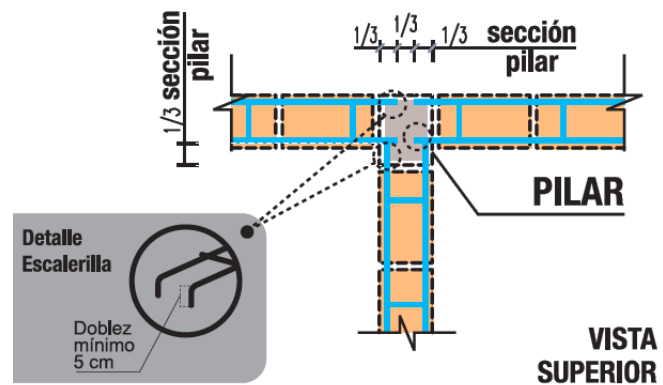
Unión paño-pilar con escalerillas (ACMA, 2011)
